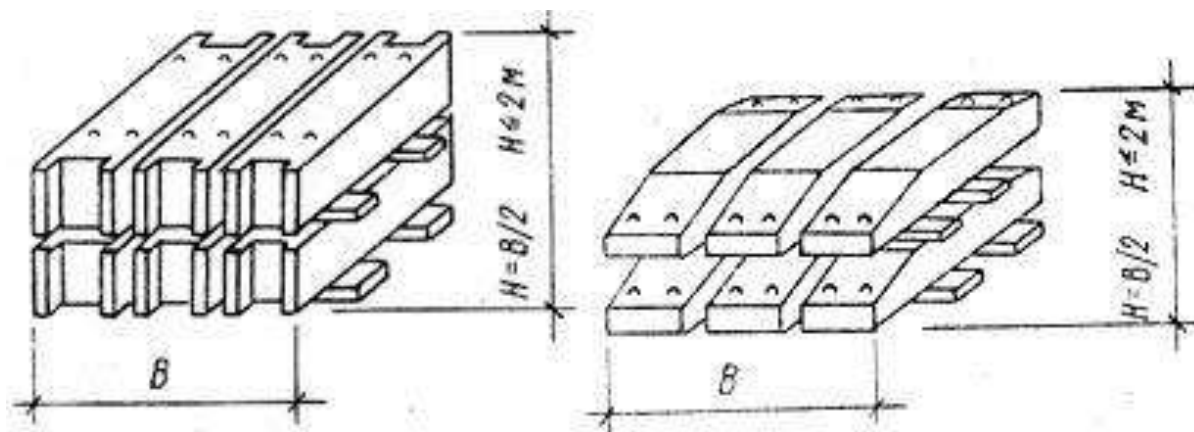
Схемы складирования стеновых блоков (слева) и фундаментных подушек (справа)
